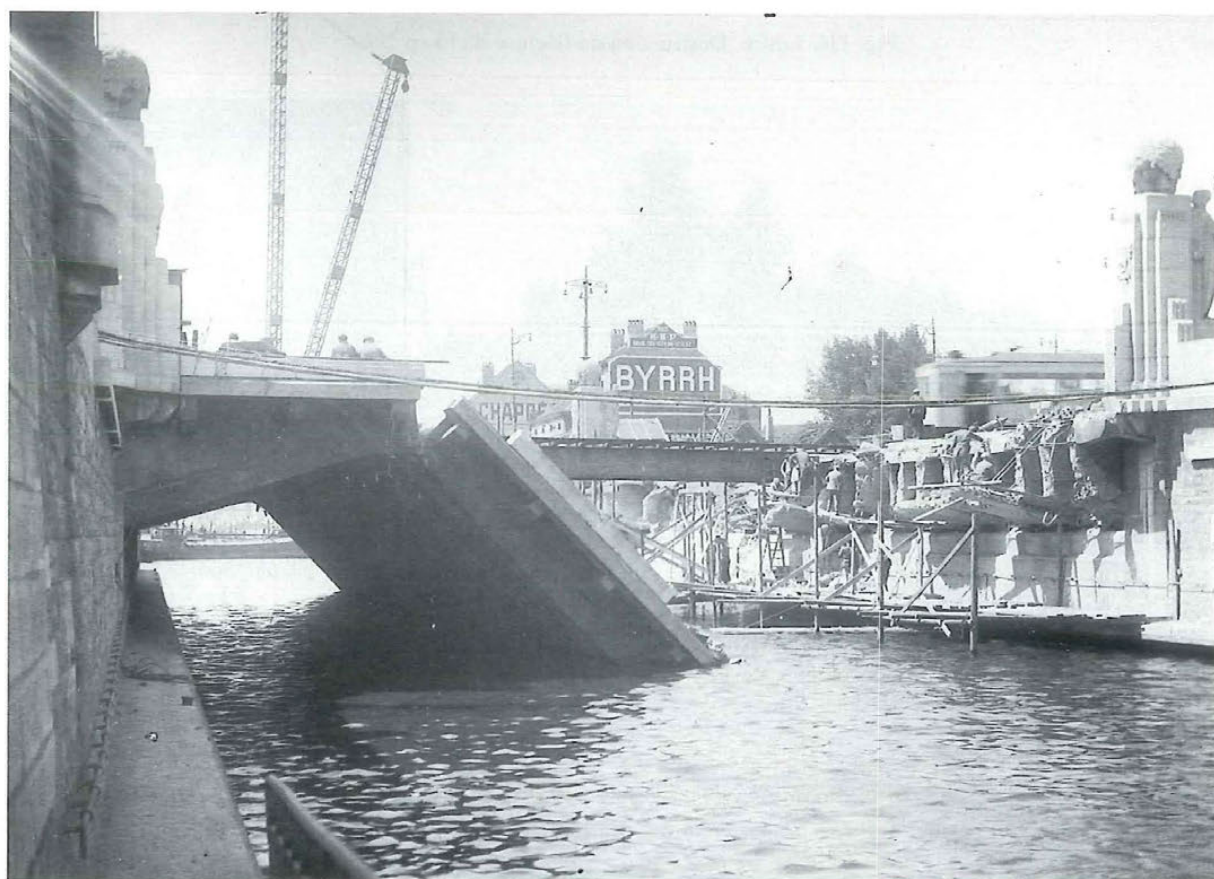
Bruxelles. Destruction du pont de la place Saintelette en 1940.
